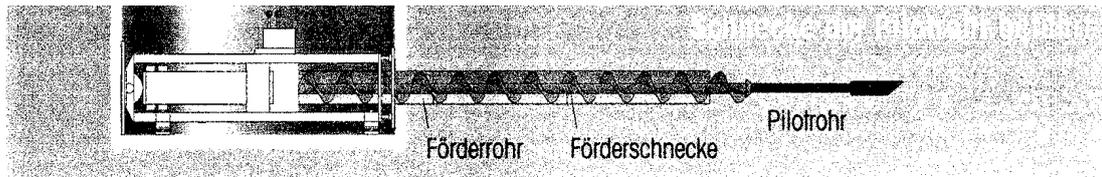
Pressbohren von Förderrohr und Schnecke am Pilotrohr geführt [1]
